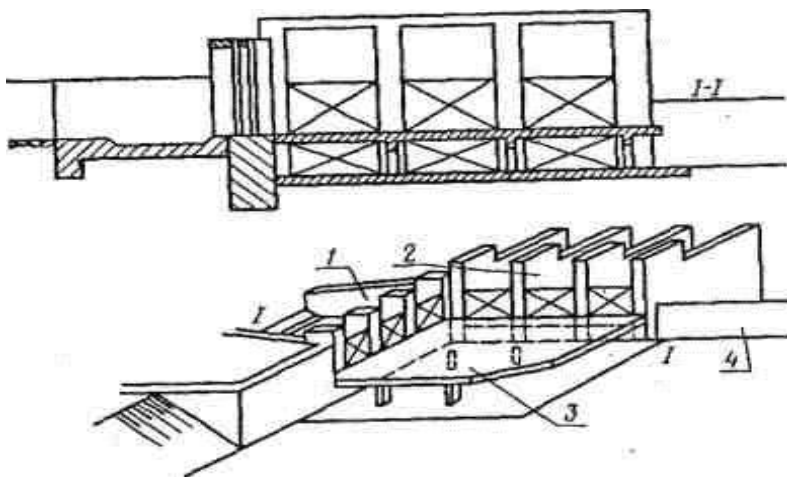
Боковой водозабор с горизонтальным полком:
